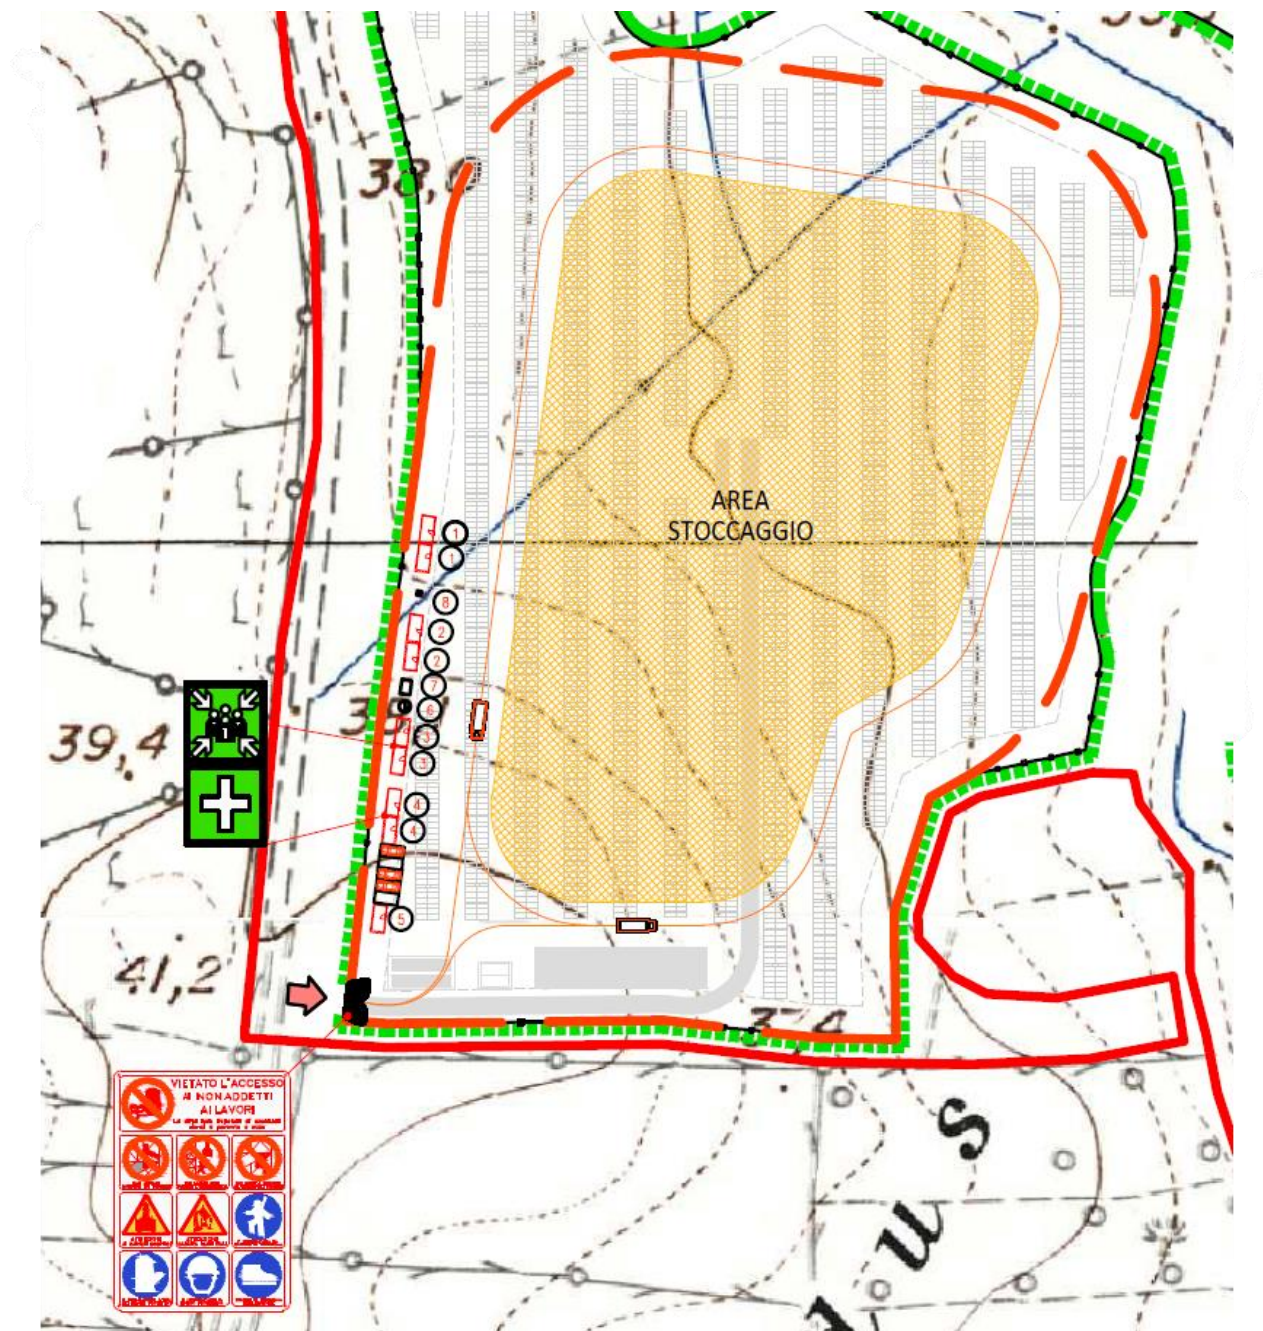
Stralcio delle aree di stoccaggio di cantiere sito Ovest.
